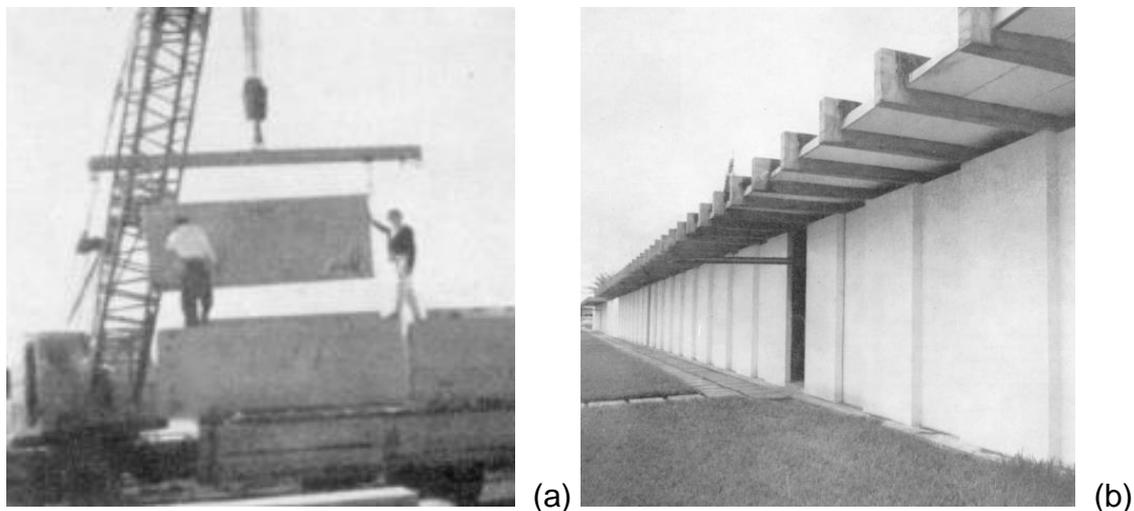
Painéis do CEPLAN: (a) içamento dos painéis por meio de guindaste (b) painéis locados
